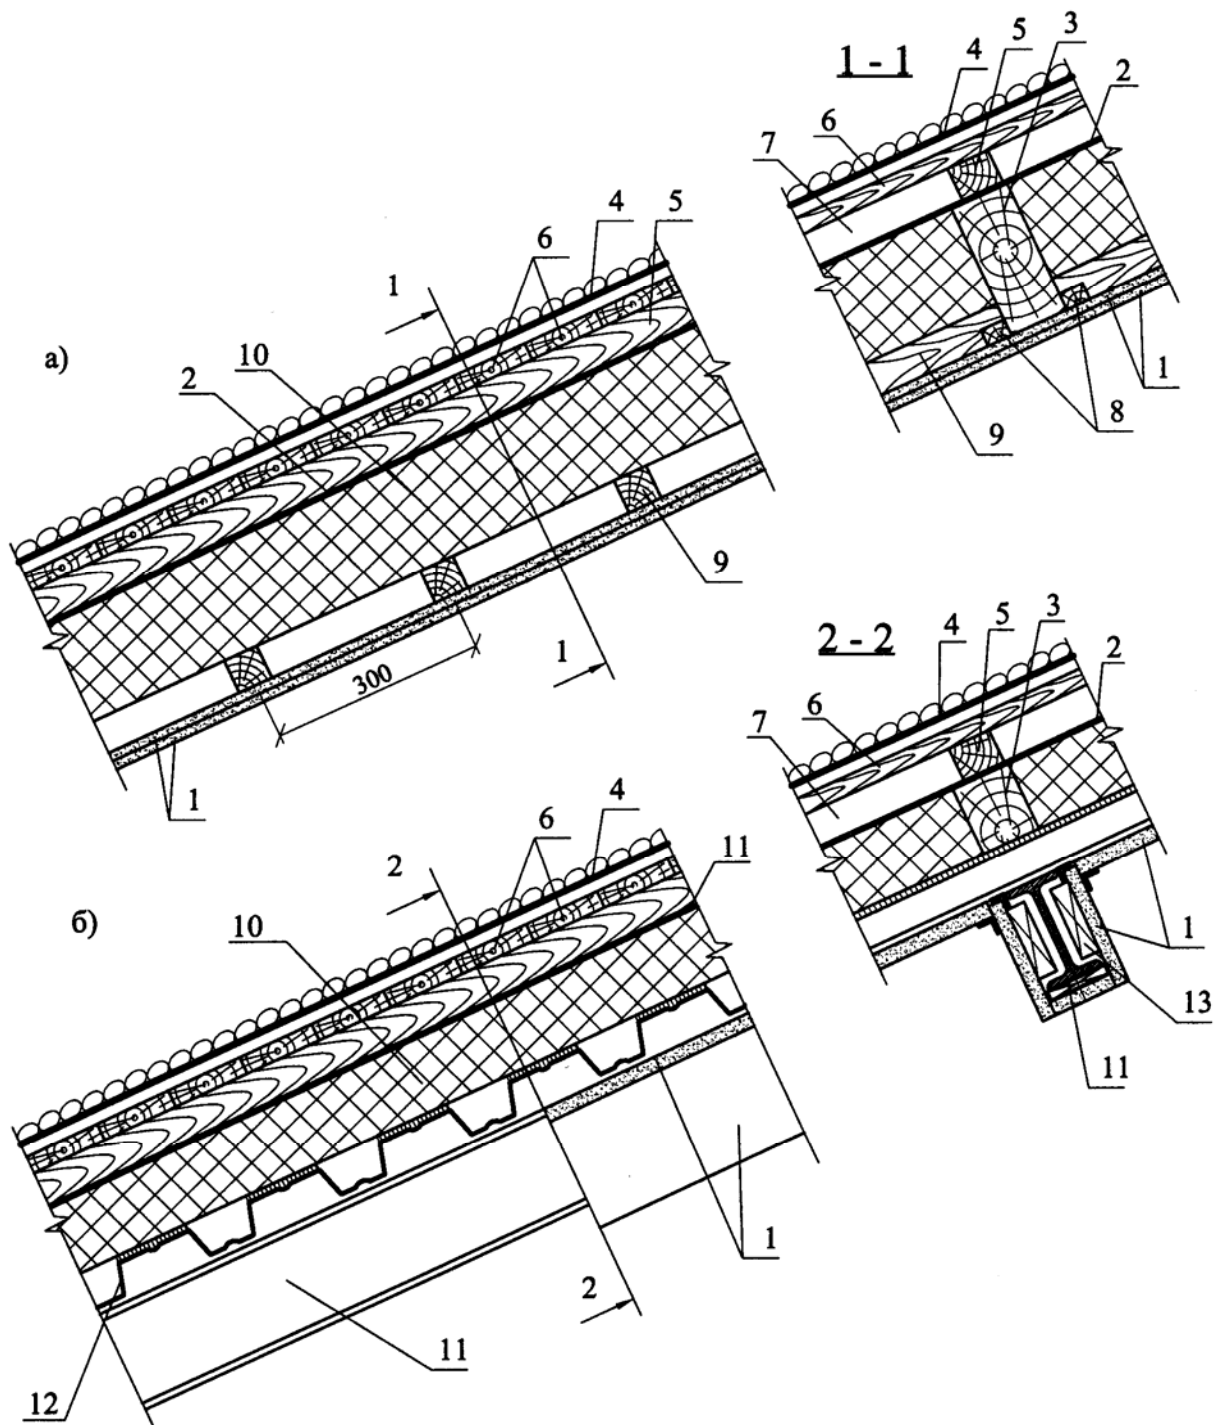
Кровля из гибкой битумной черепицы в покрытии по деревянному настилу (а)
